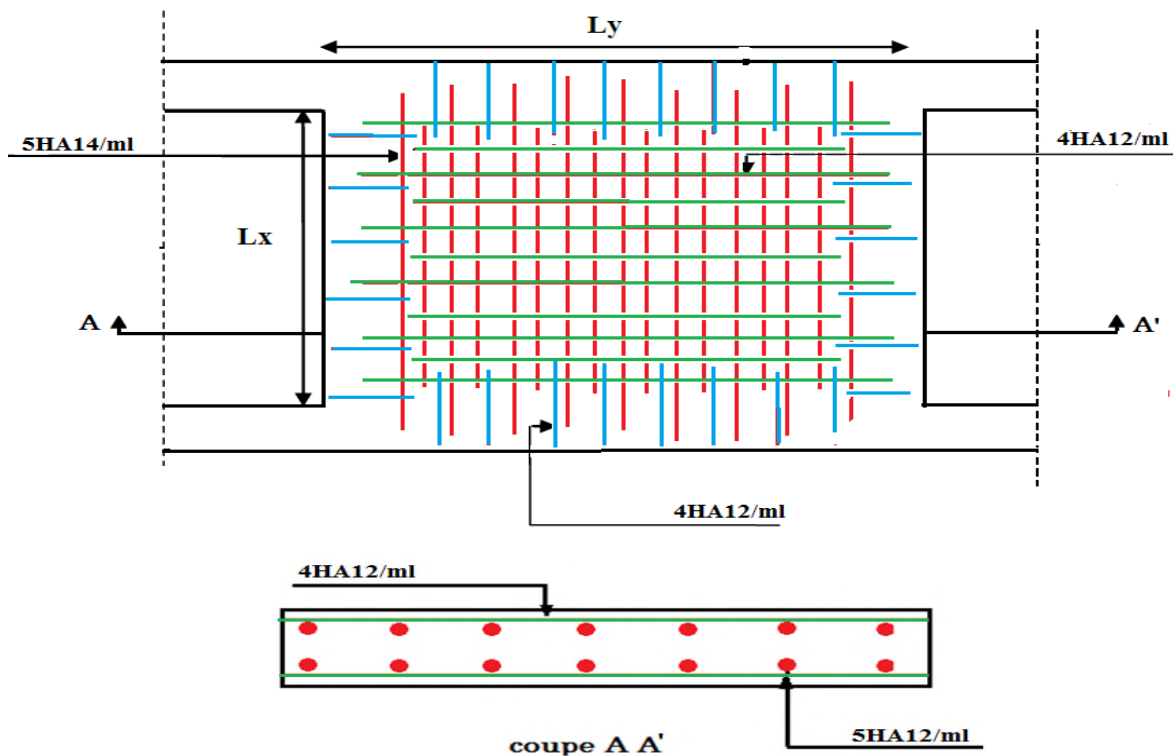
Schéma de ferrailage du mur de soutènement.
